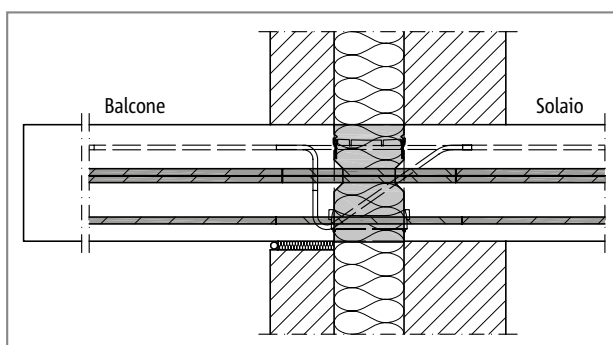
Schöck Isokorb® tipo KXT, EQXT: muratura bistrato con interposto isolamento
